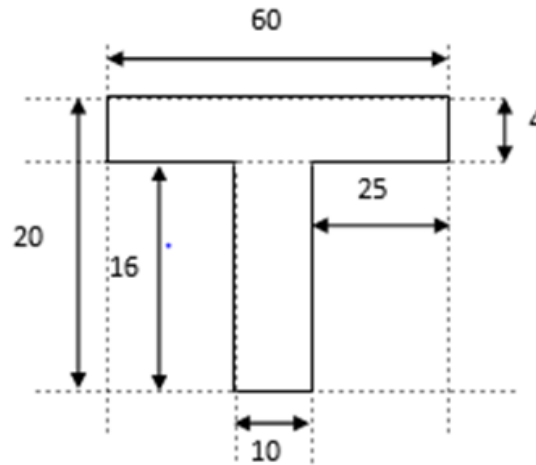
Schéma de poutrelle (Section de calcul).
